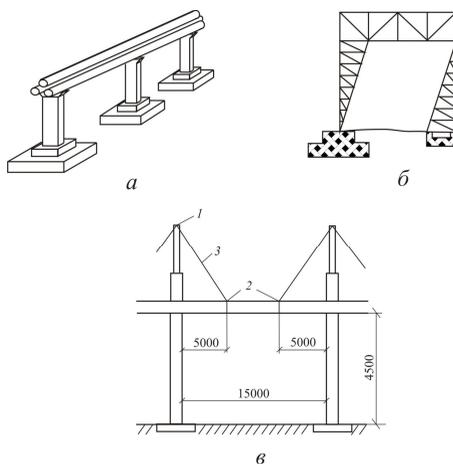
Основные виды надземной прокладки трубопроводов:
